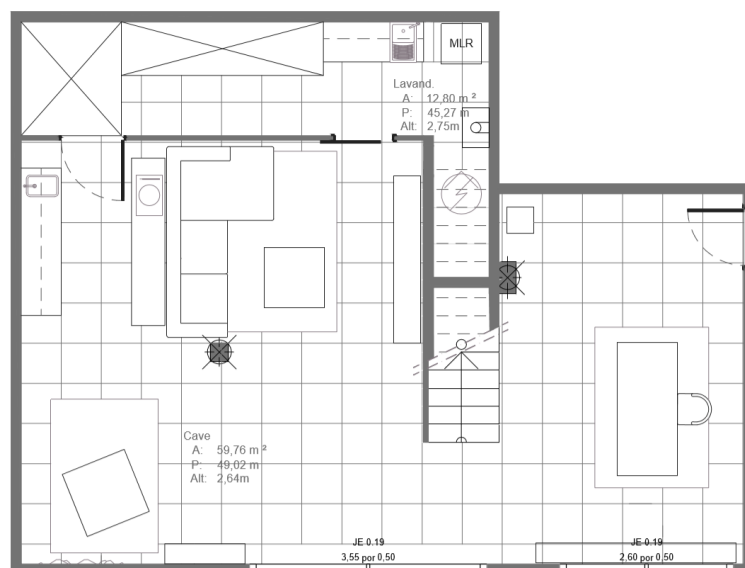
Planta de Apresentação Cave - Opção 02. Fonte: autor
